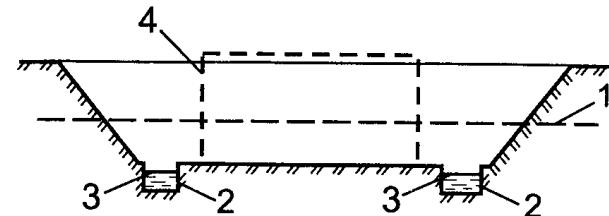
Схема устройства канав для устраниния действия напорных вод на грунтовое основание:
